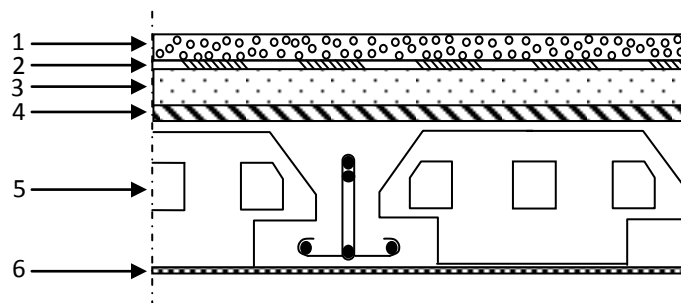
Détail des constituants du plancher terrasse inaccessible.
